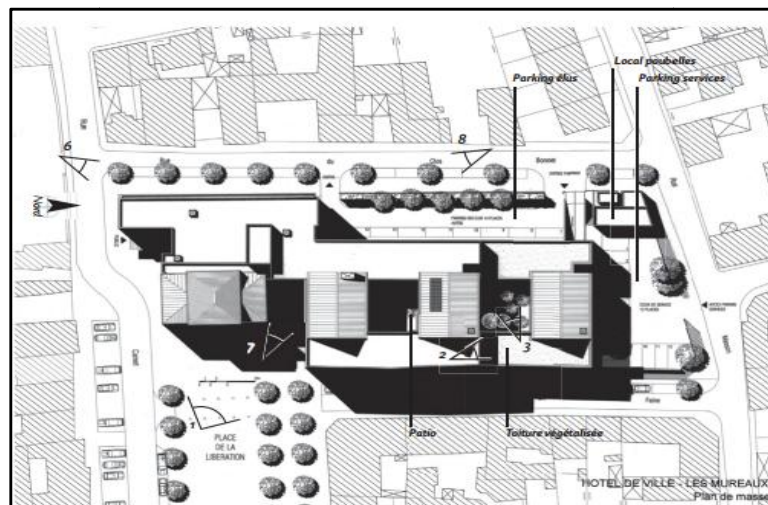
Plan de masse de La Mairie des Mureaux (Source : Ekopolis, 2010).
